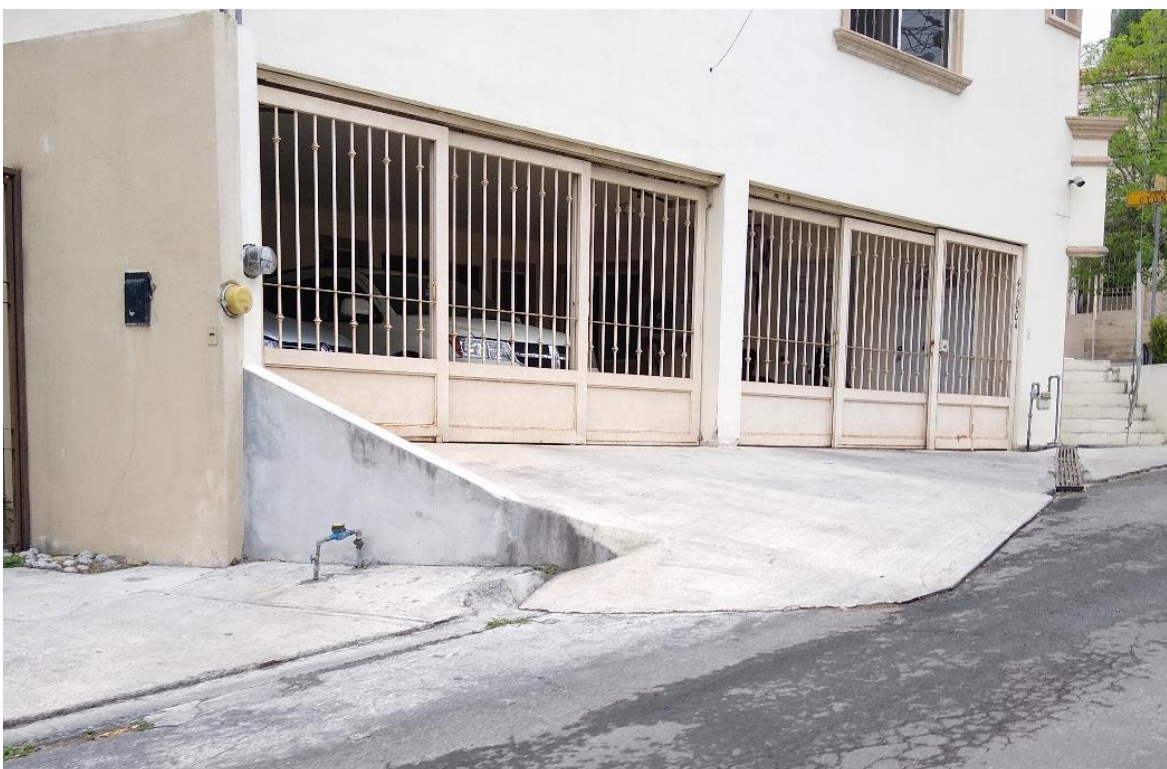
Rampas de acceso que obstaculizan la calle y desaparecen la banqueta en Villa las Fuentes. Colección personal, foto tomada por Juana Déciga.
